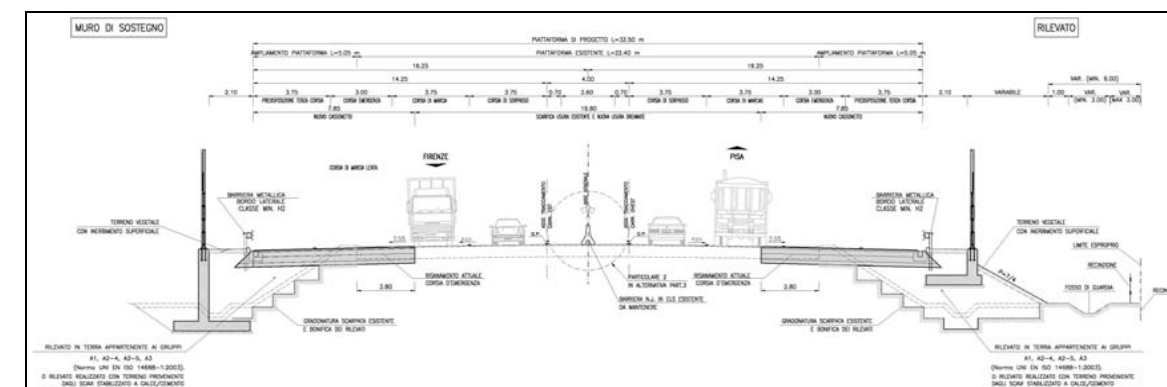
Sezione tipo in ampliamento simmetrico
